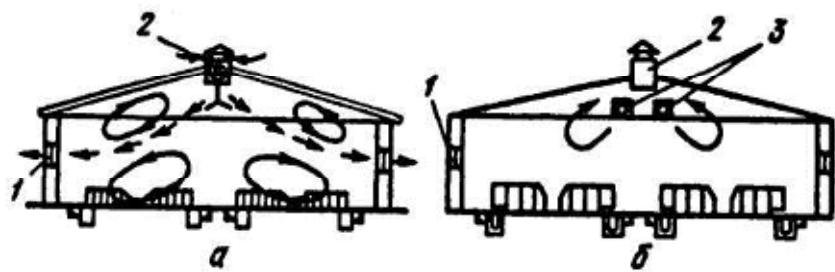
Вентиляция животноводческих помещений по схеме с избыточным давлением и вентиляторами, расположенными на крыше: а - теплый период года; б - холодный период; 1 - оконные проемы; 2 - вытяжные шахты; 3 - приточный воздуховод
